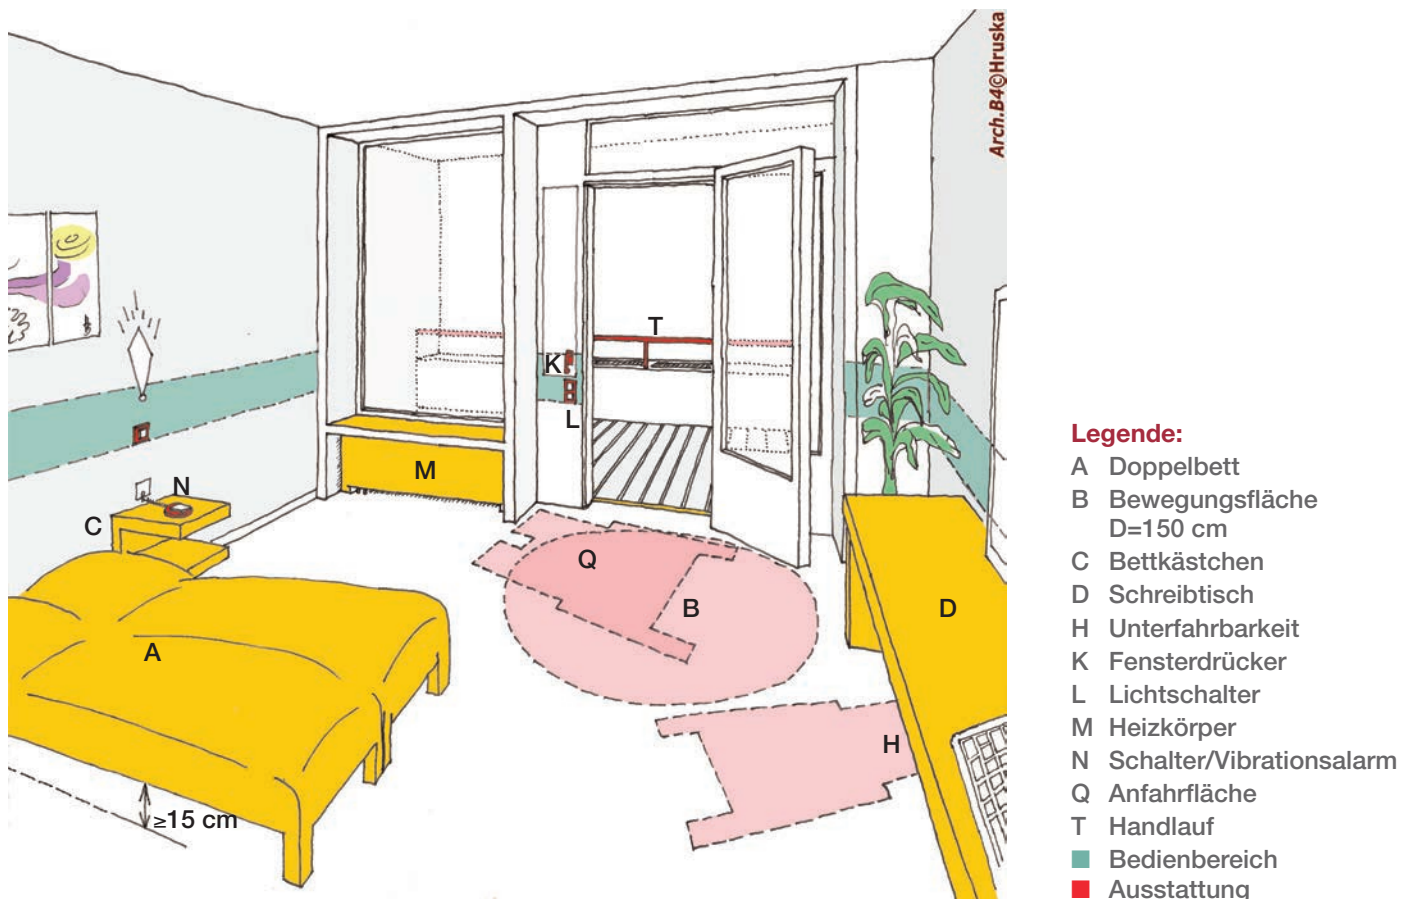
Gästezimmer/Hotelzimmer mit unterfahrbarem Doppelbett
